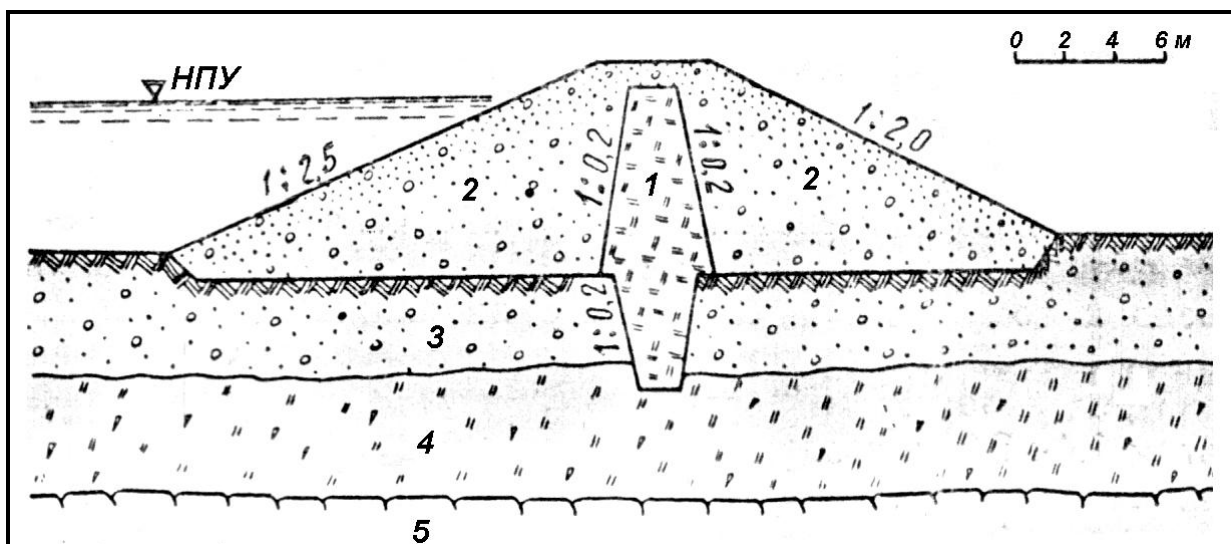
Земляная насыпная плотина на ручье Кадыкчан, 1966 г.
